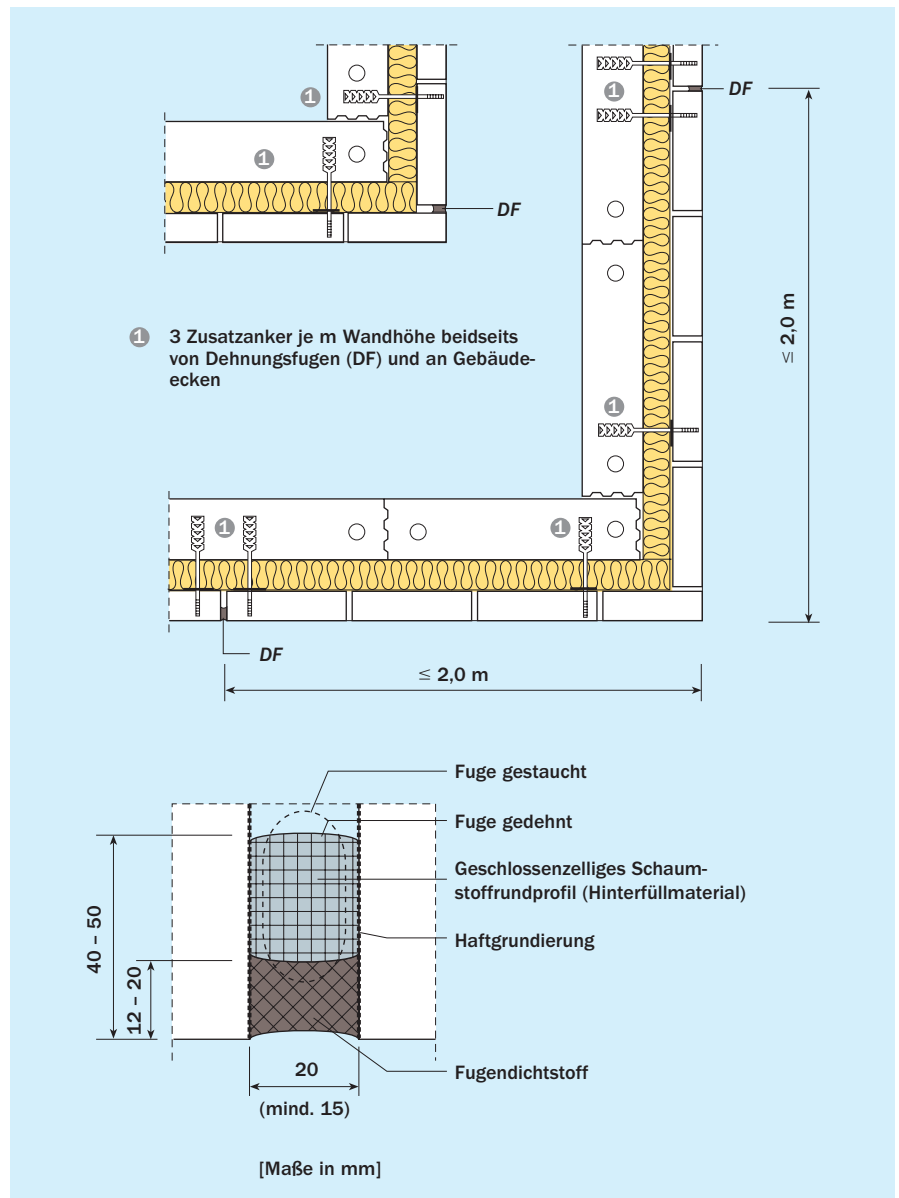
Verblendschalen mit vertikaler Dehnungsfuge (DF) an den Gebäudeecken
